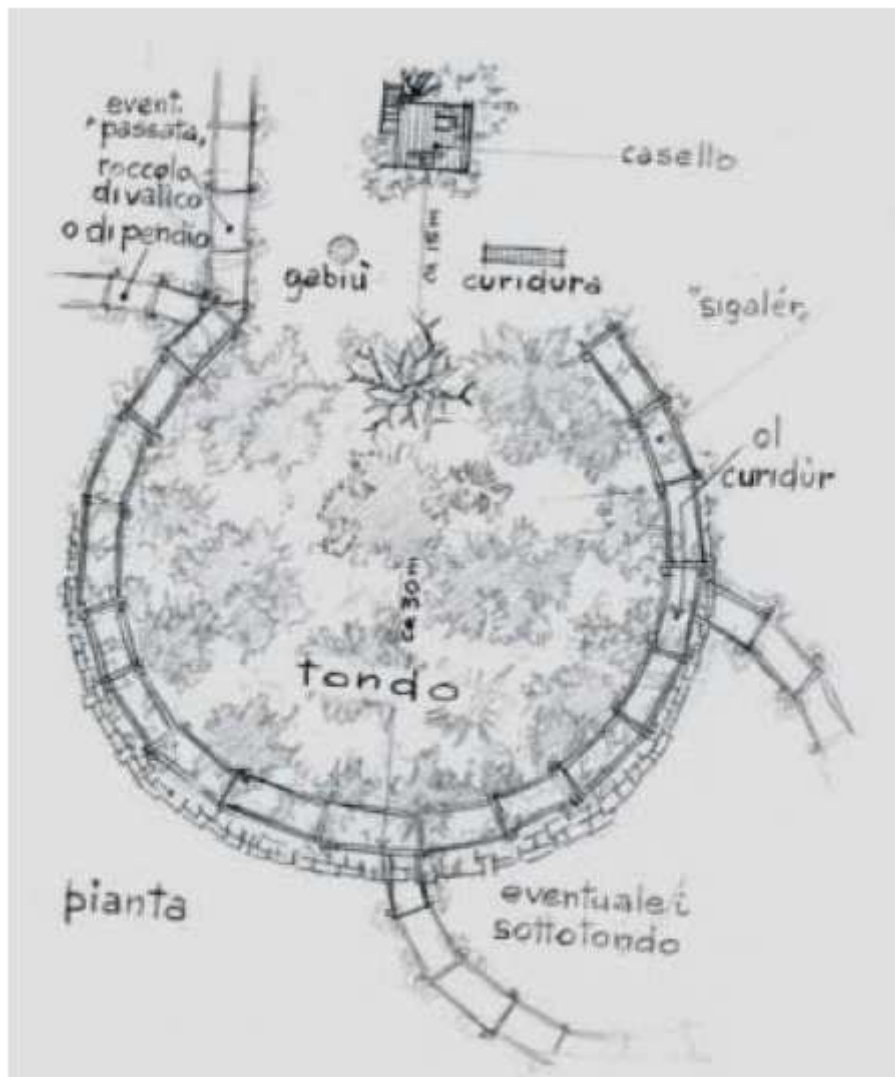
Pianta del roccolo (CALEGARI – RADICI – MORA, 1996, p.39)
